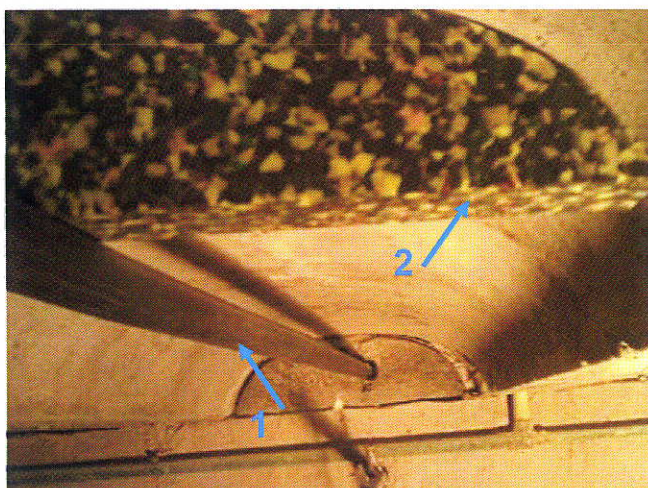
Onderzijde BG vloer met intact naspansysteem. Spankabel (1) en kunststof drukklok (2) in spiegel van Kwaaitaal vloerelement. BG vloer met intact naspansysteem. Spankabel (1) door kopschot.
